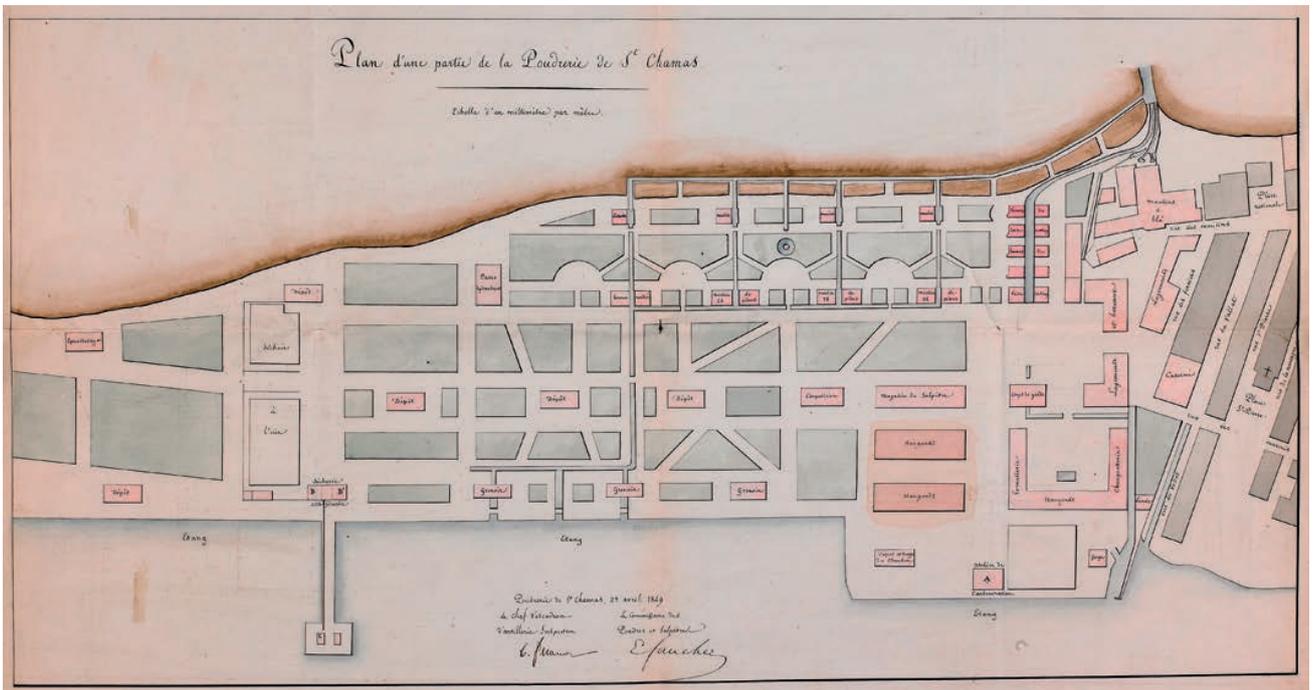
Plan d'agrandissement de la Poudrière 1849 (AD BDR : 5 M 626).
